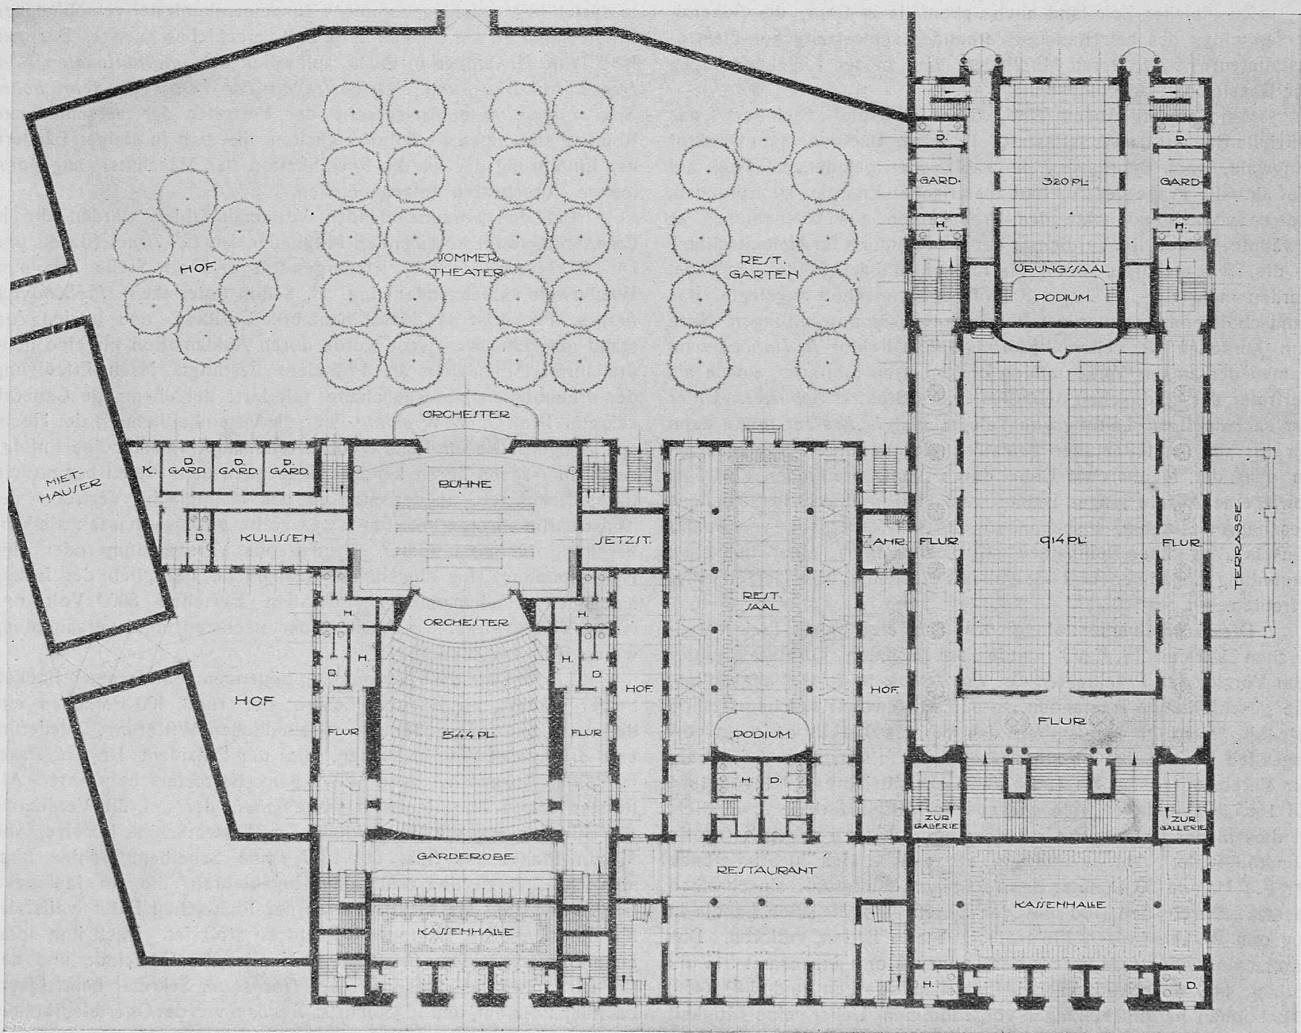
Grundriss vom Zwischengeschoss. — Masstab 1 : 600.
